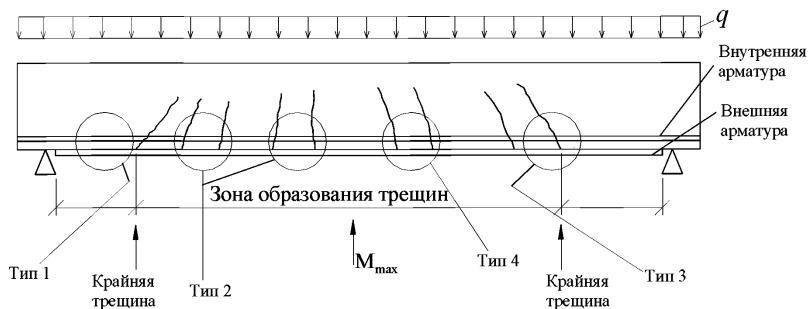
Типы разрушения железобетонной конструкции, усиленной полосой композита
